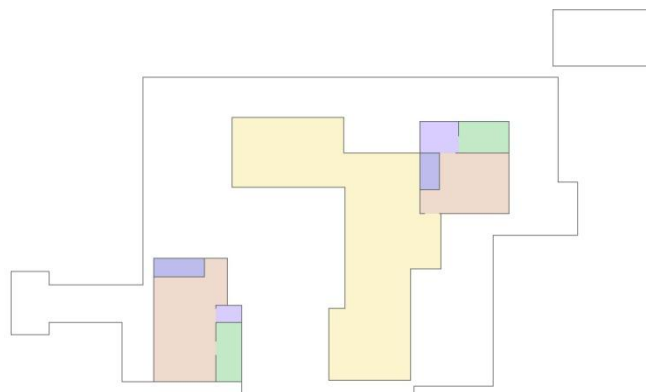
Plano de 1ª planta. Incluye cubiertas del primer nivel
